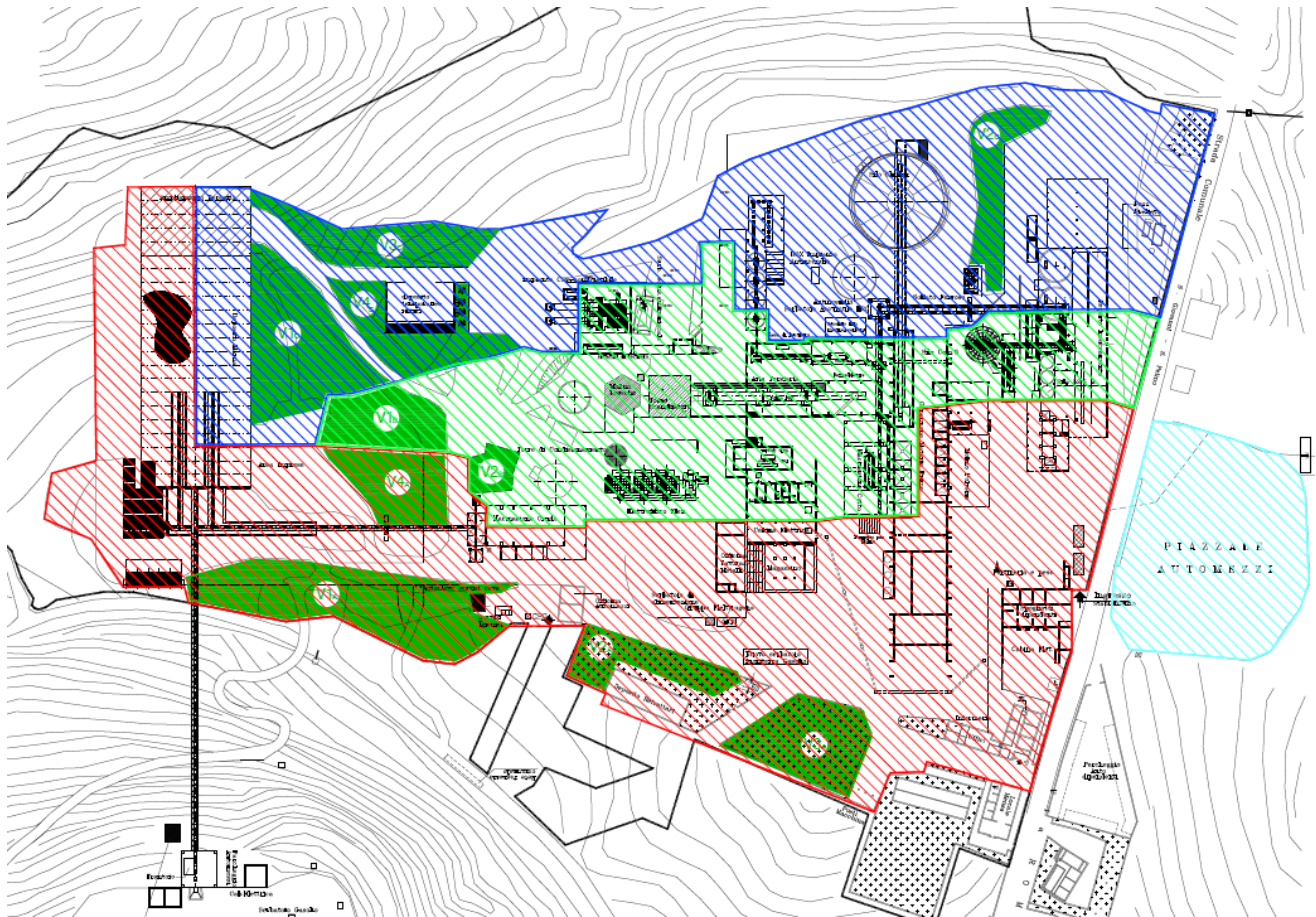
stralcio planimetria con individuazione superfici scolanti
